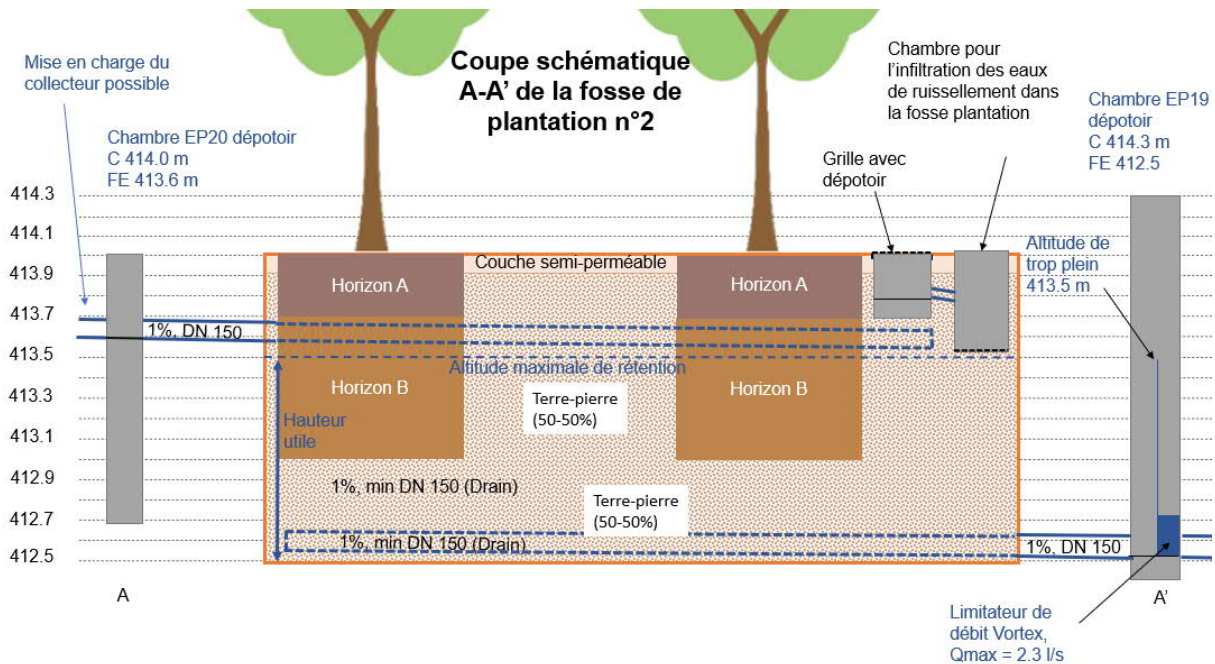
Coupe A - A' de la fosse de plantation n°2
